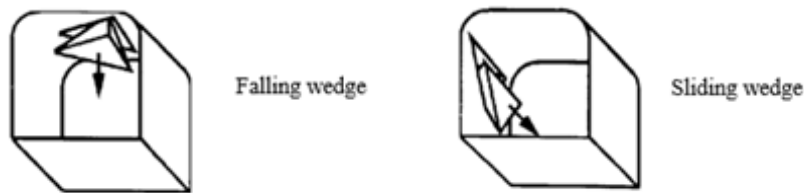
Cuña descendente y cuña deslizante. Fuente: E. Hoek (2000). *Structurally controlled instability in tunnels. En Rock Engineering. Course notes, p. 73.
